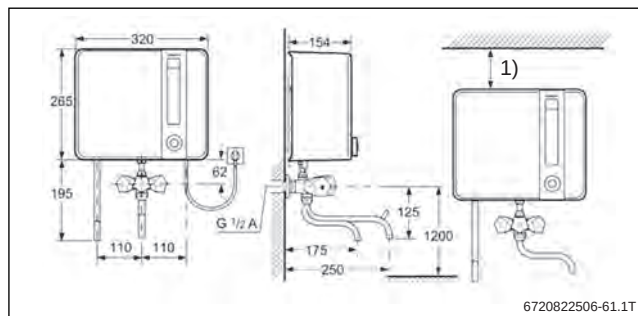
Abmessungen Tronic 1000 K (Maße in mm)
